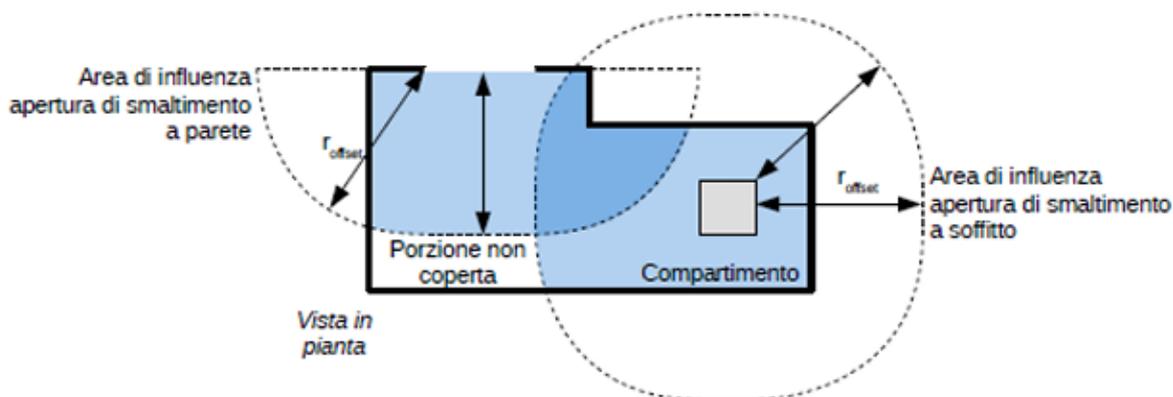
Verifica dell'uniforme distribuzione in pianta delle aperture di smaltimento
